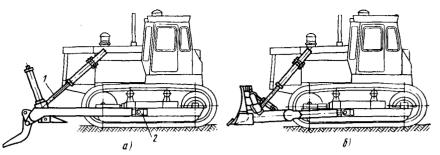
Агрегат для строительства и содержания лесовозных дорог ЛД-4: корчеватель ЛД-9; б — универсальный отвал ЛД-10; 1 — гидроцилиндр подъема и опускания навесного оборудования; 2 — монтажный кронштейн
